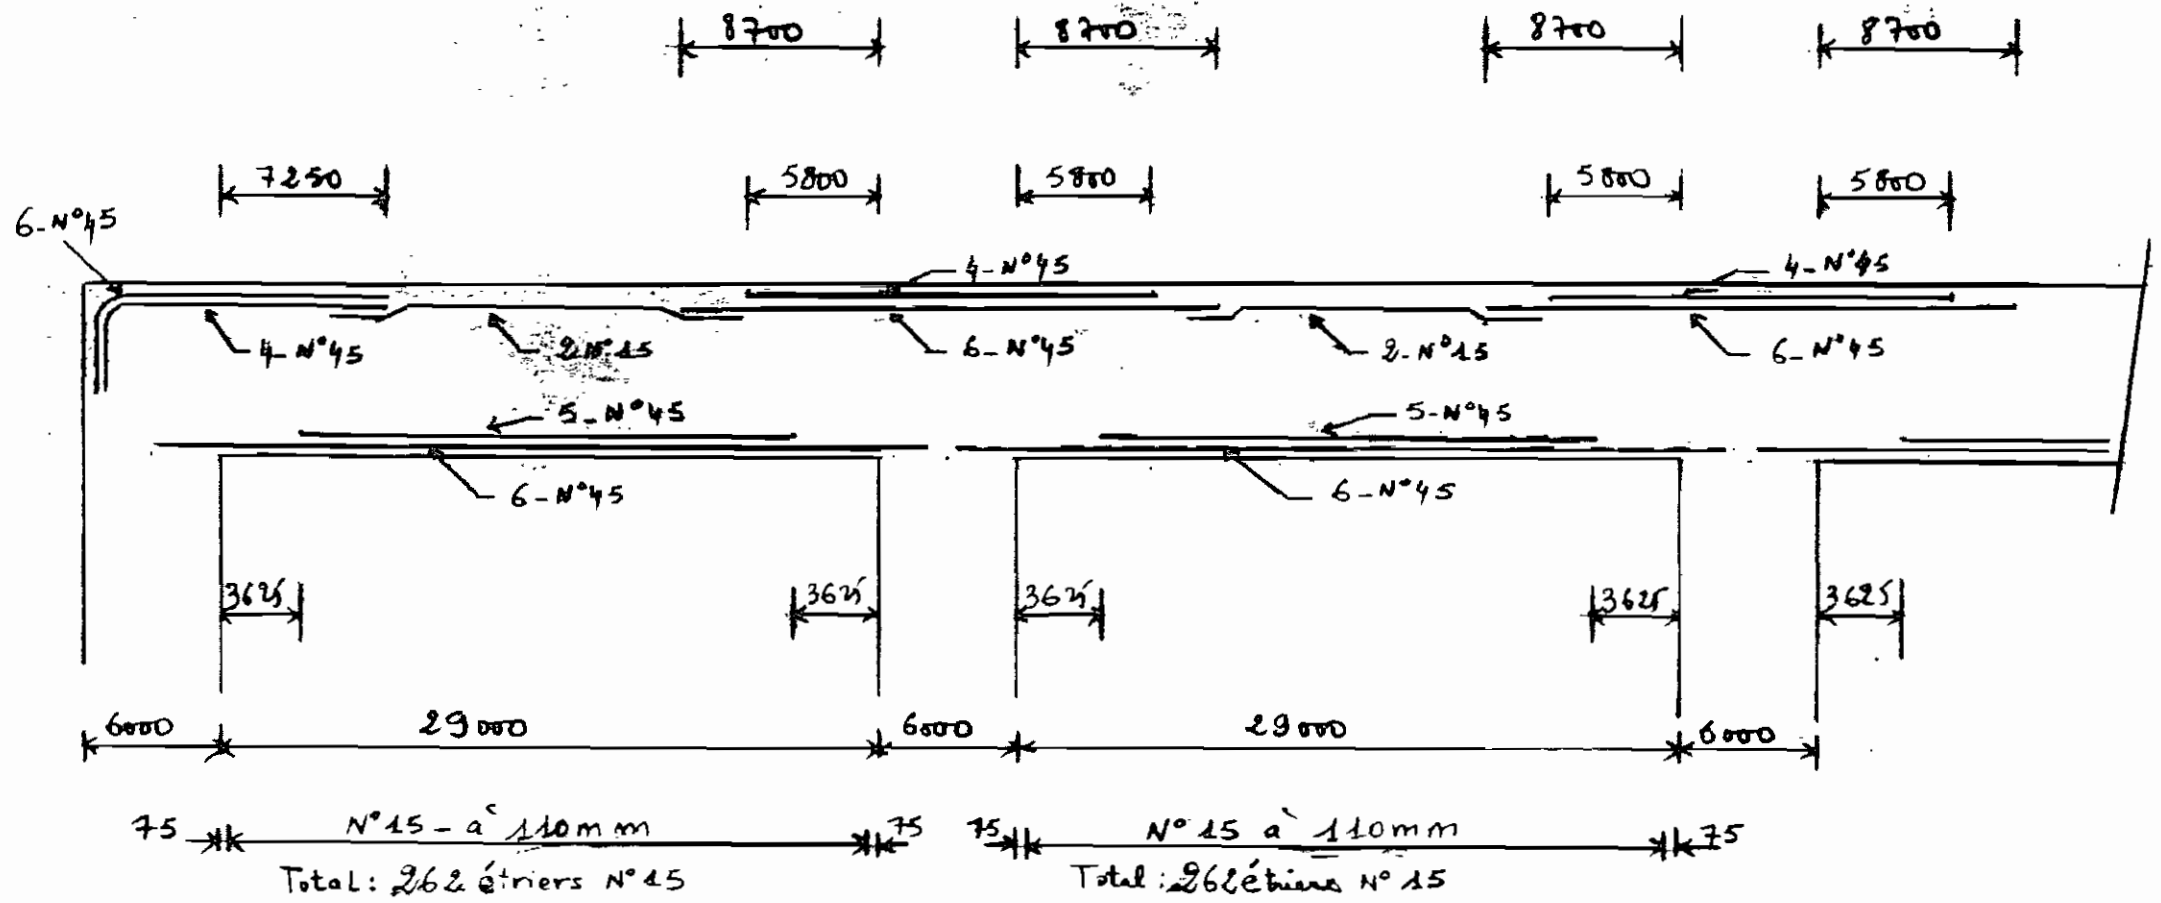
Schéma de ferrailage de la poutre principale de rive.
